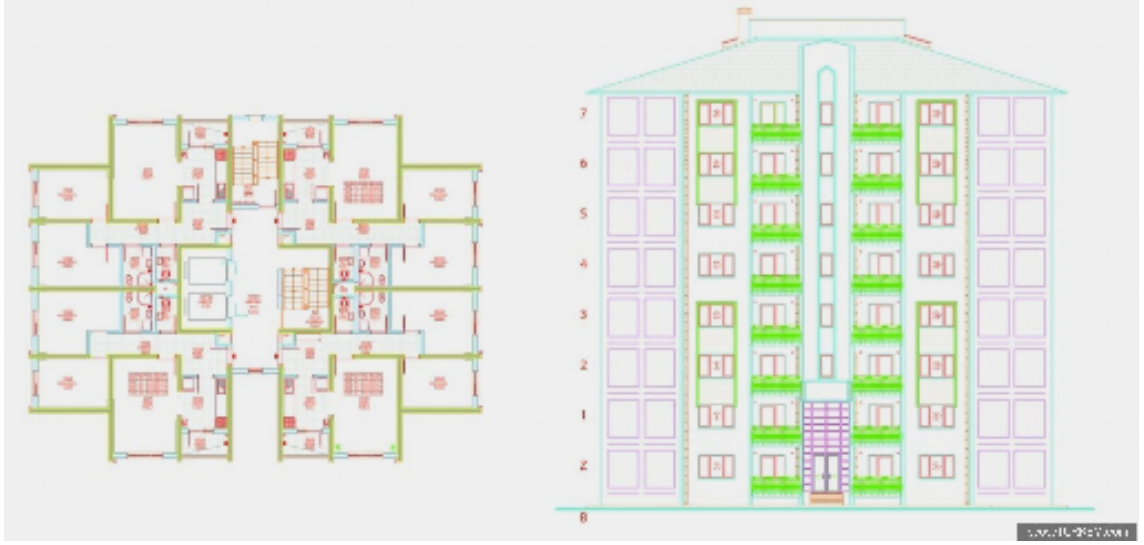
TOKİ Hasanağa Vaziyet Planı
